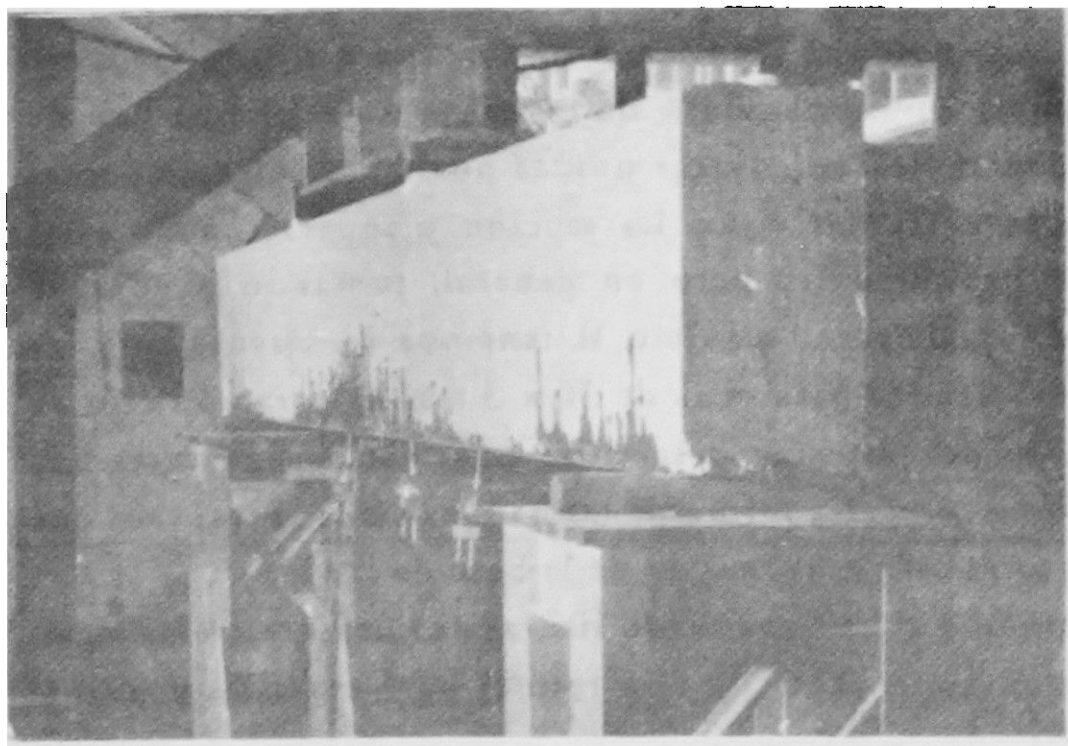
Viga de hormigón a la que se le ha colocado la armadura exteriormente en forma de banda de acero unida con resinas epoxi.
